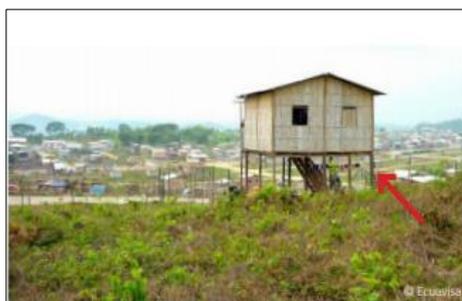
Ausencia de arriostamiento en la Vivienda de transición
